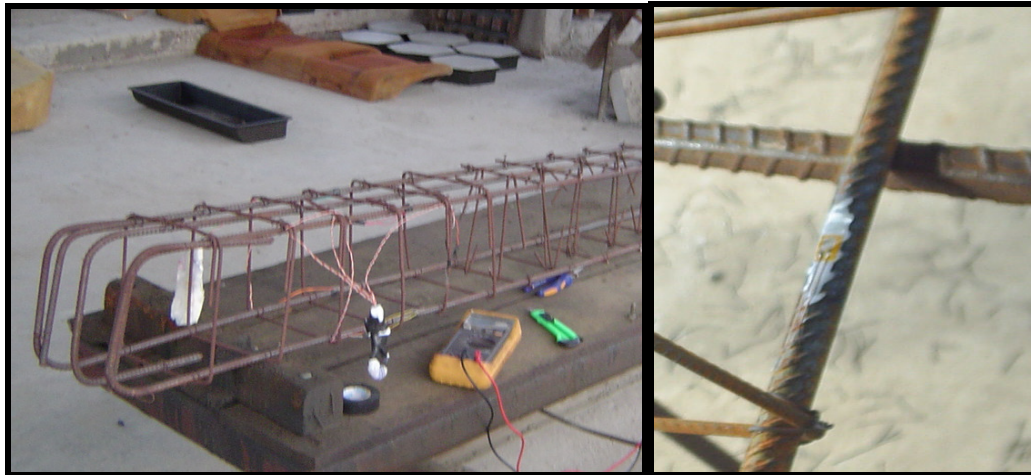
Armaduras instrumentadas com os extensômetros
